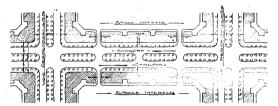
Plan d'une voie de largeur : 40 mètres.
